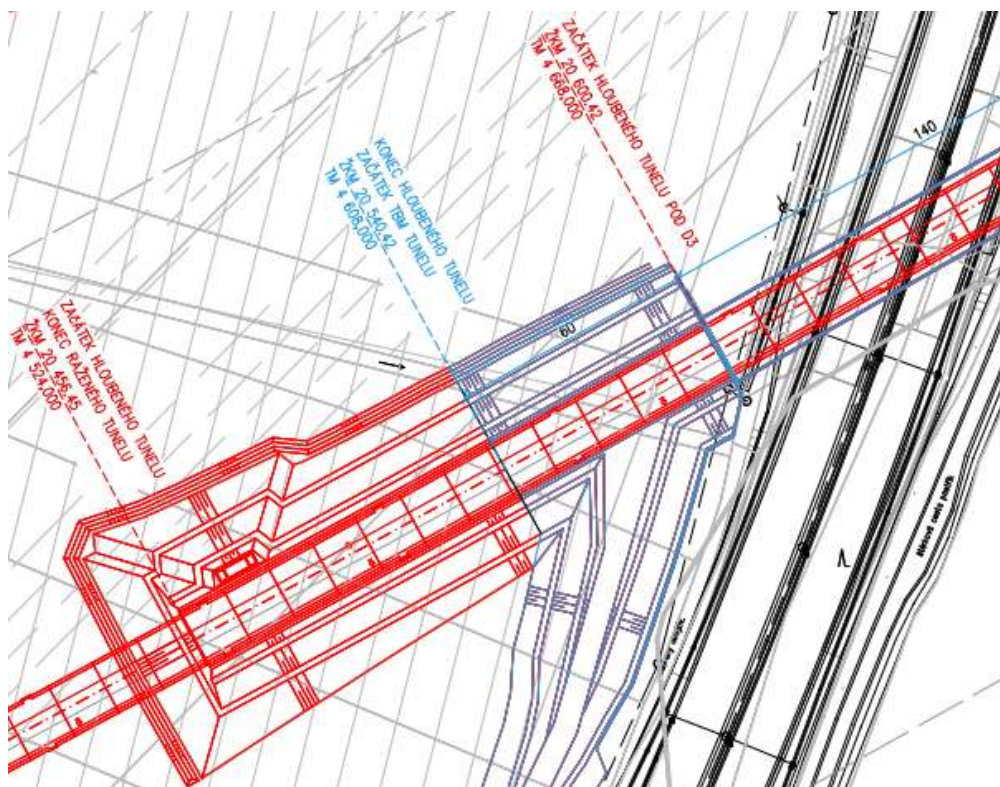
Výkop stavební jámy – vjezdový portál Chotýčanského tunelu
